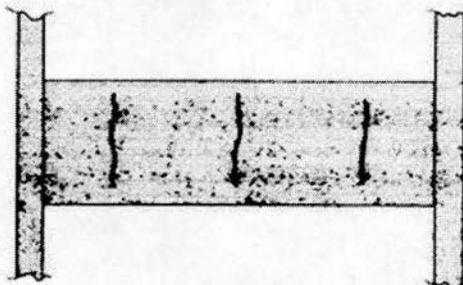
Fisuras de contracción hidráulica o de desplazamientos térmicos
